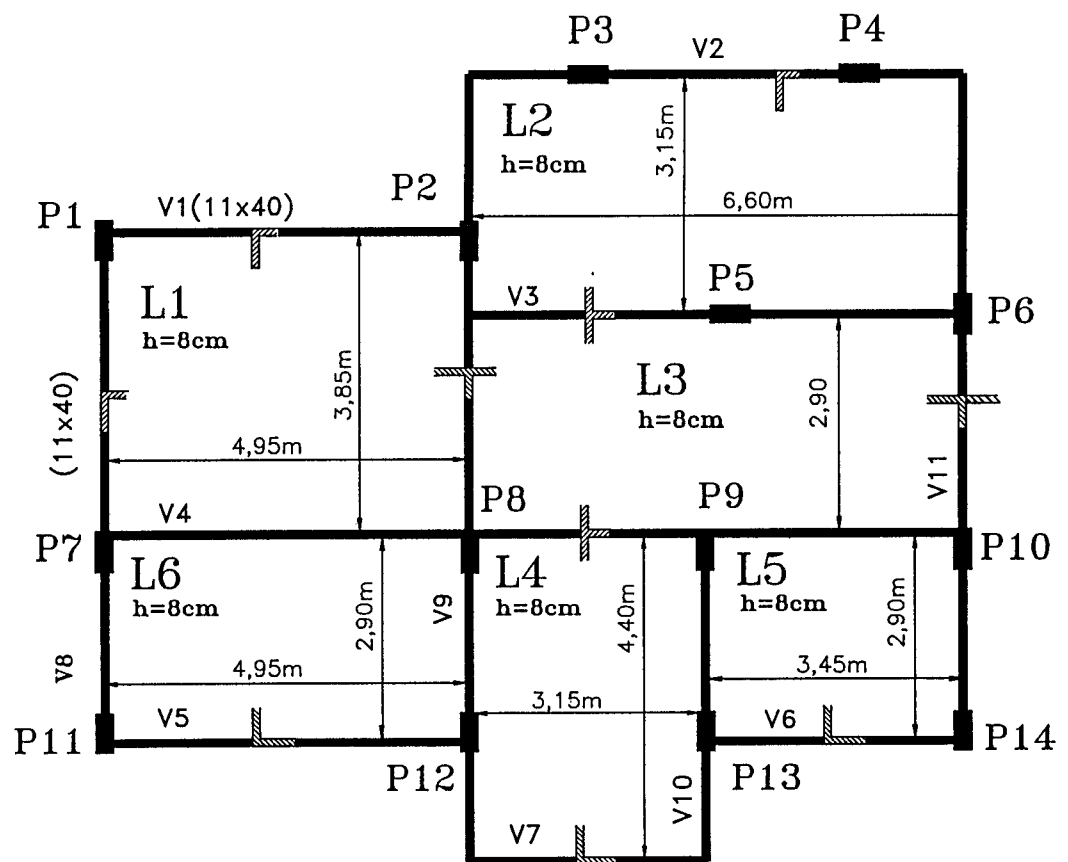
ESTRUTURA 1.2 - FORMAS - LAJE MACIÇA
